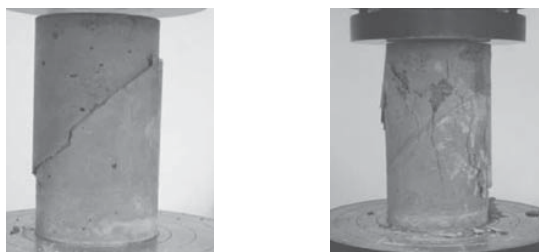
供試体の破壊状況(左:従来工法、右:接着剤工法)
